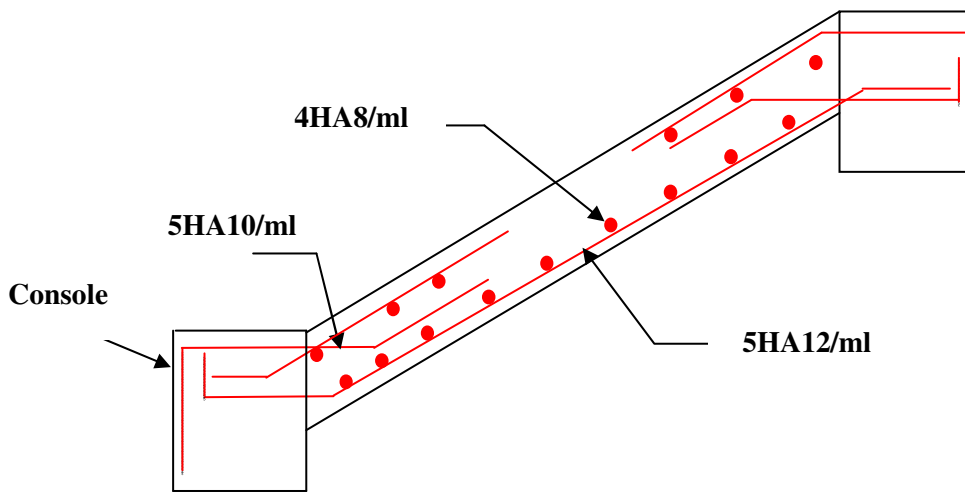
Schéma de ferrailage de l'escalier duplex.
